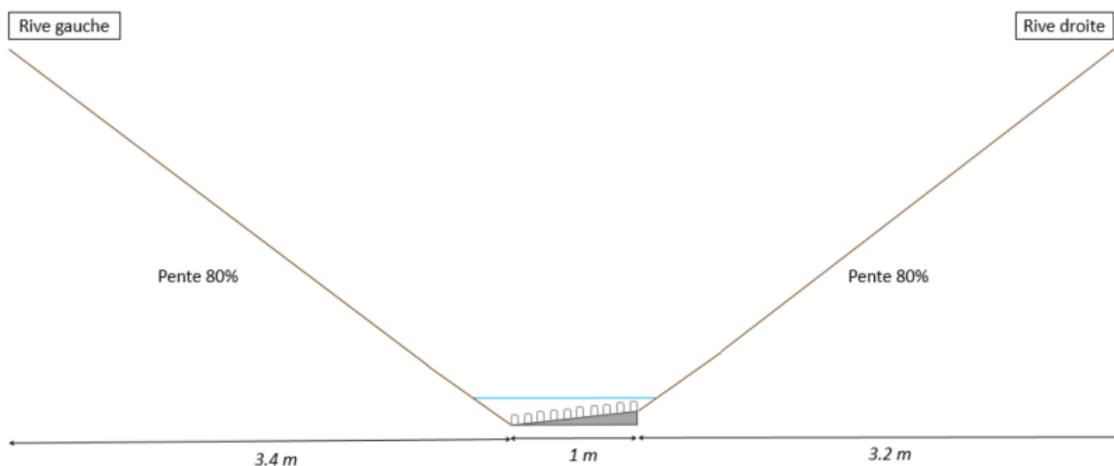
Profil en travers type de la rampe evergreen avec ouverture du Steinbach en fin de rampe (au niveau du local technique)
